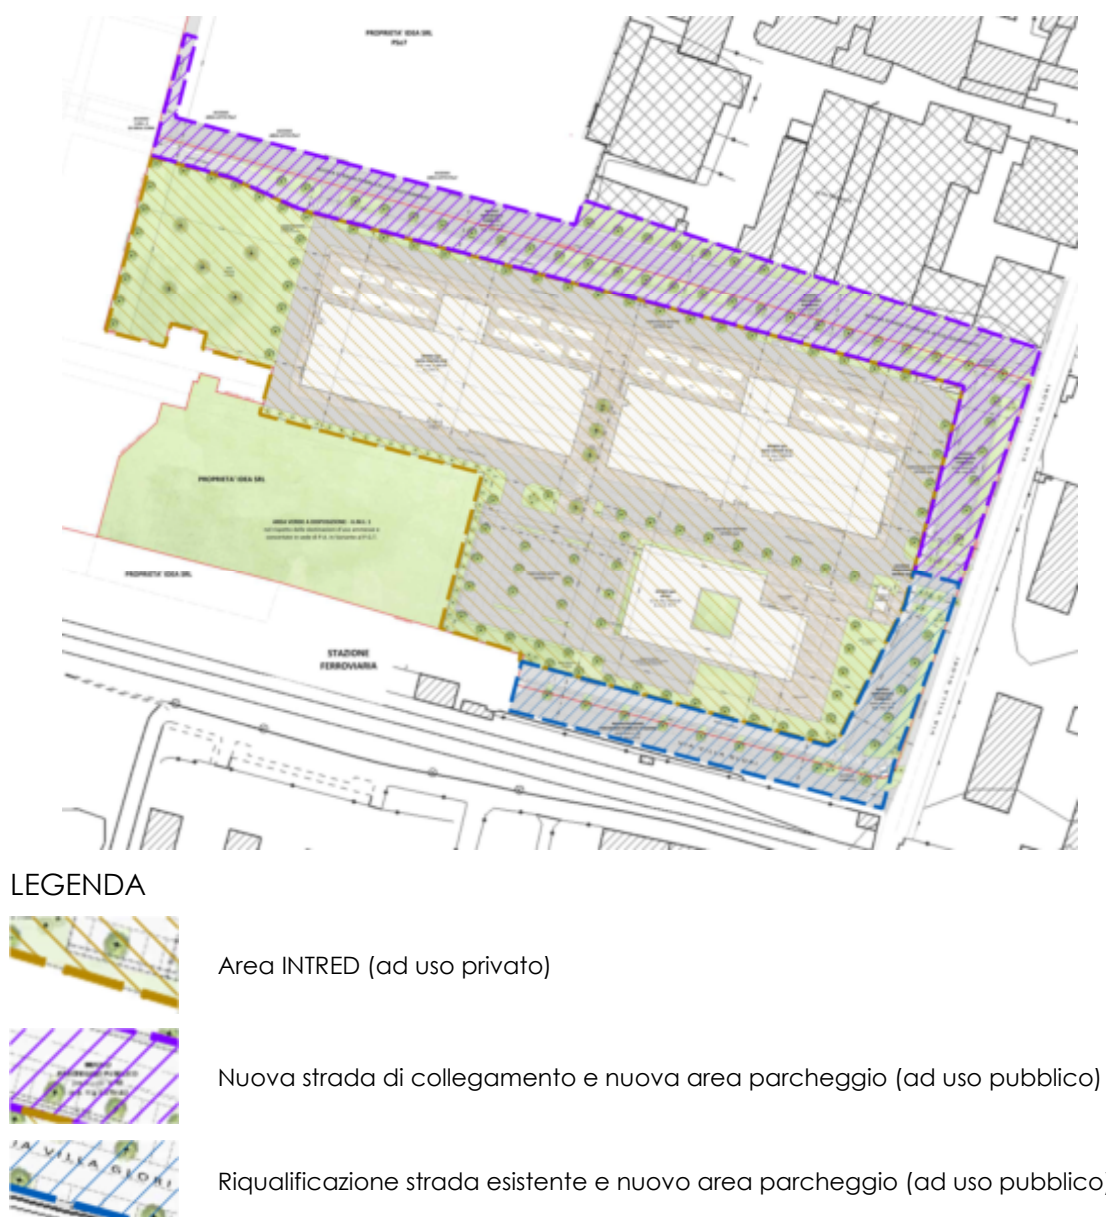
Planimetria generale dell'intervento con distinzione aree pubblico-private
